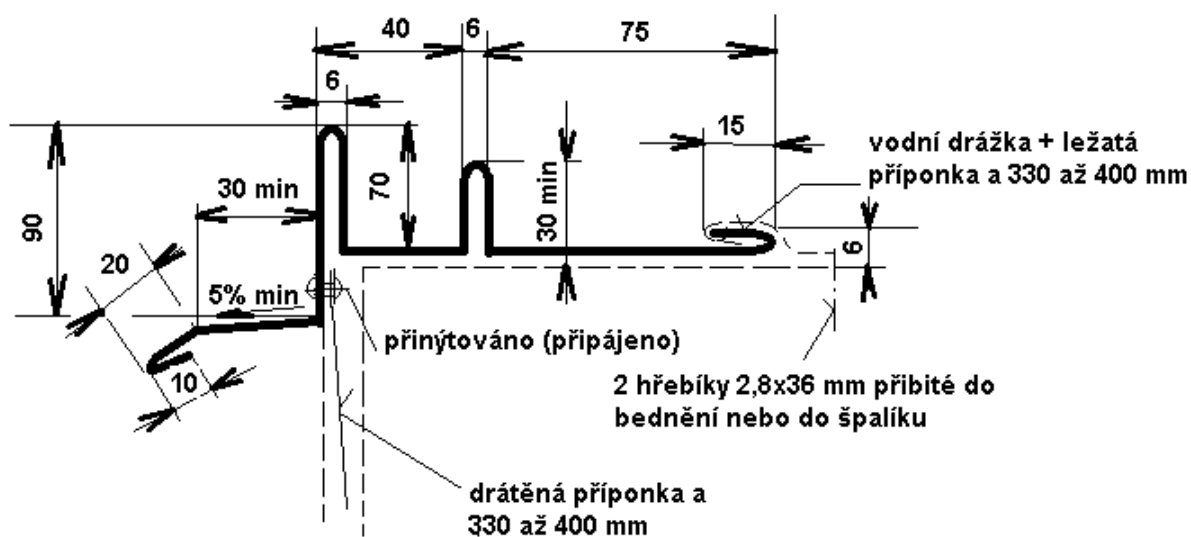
Prvky střešní konstrukce (Autor textu)
